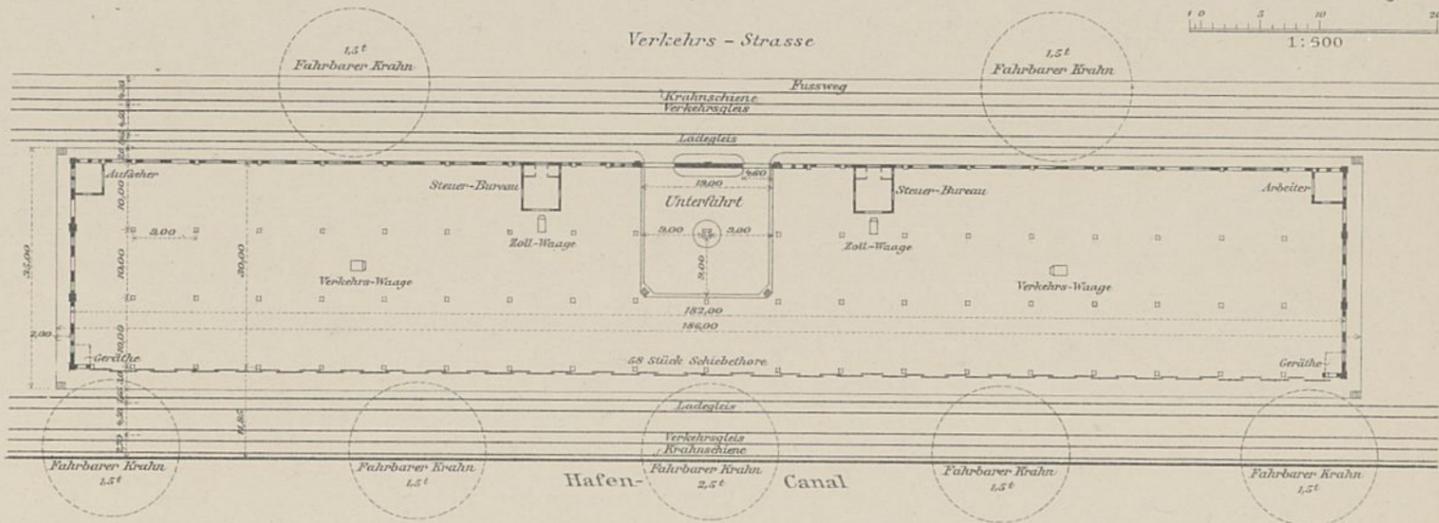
Grundriss des Kaischuppens. 1:1000.
